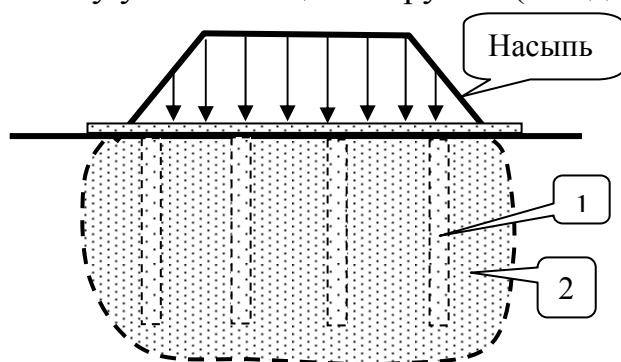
Глубинное уплотнение грунта основания пригрузкой
